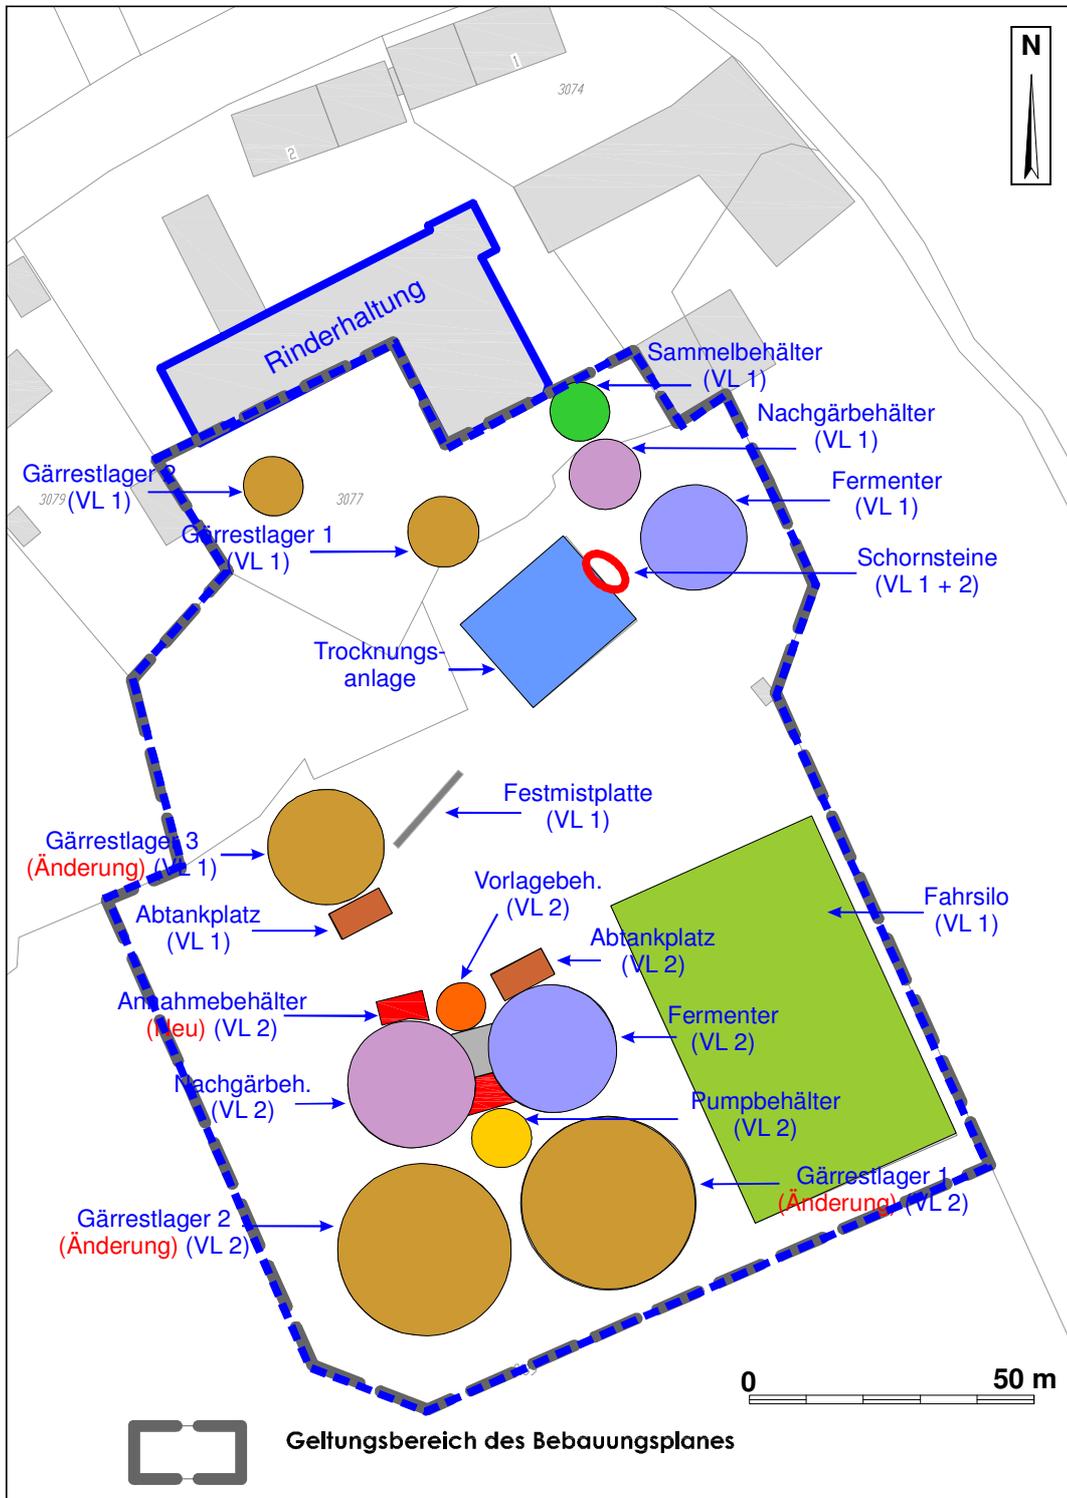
Lageplan der Biogasanlage Bauer. Zur Änderung vorgesehene oder neue Anlagenteile sind in roter Schrift gekennzeichnet (Plangrundlage: Sewald GmbH & Co. KG, PlanNr. 2014-0240-4-BP, 14.05.2014, Bebauungsplan Nr. 70, „Sondergebiet Biogasanlage Schaftlding“)
